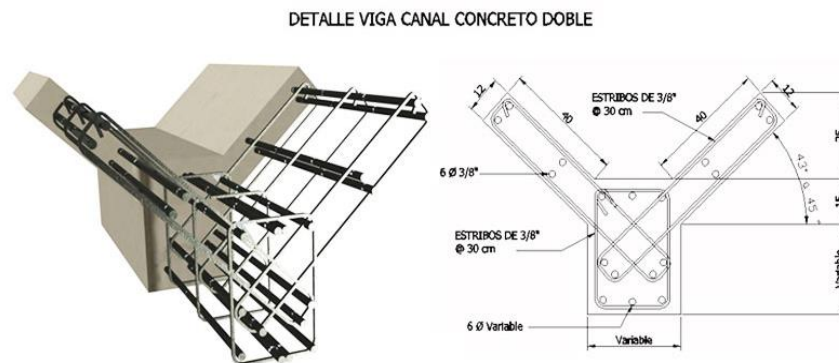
Viga canal para puente de concreto.⁵⁵
